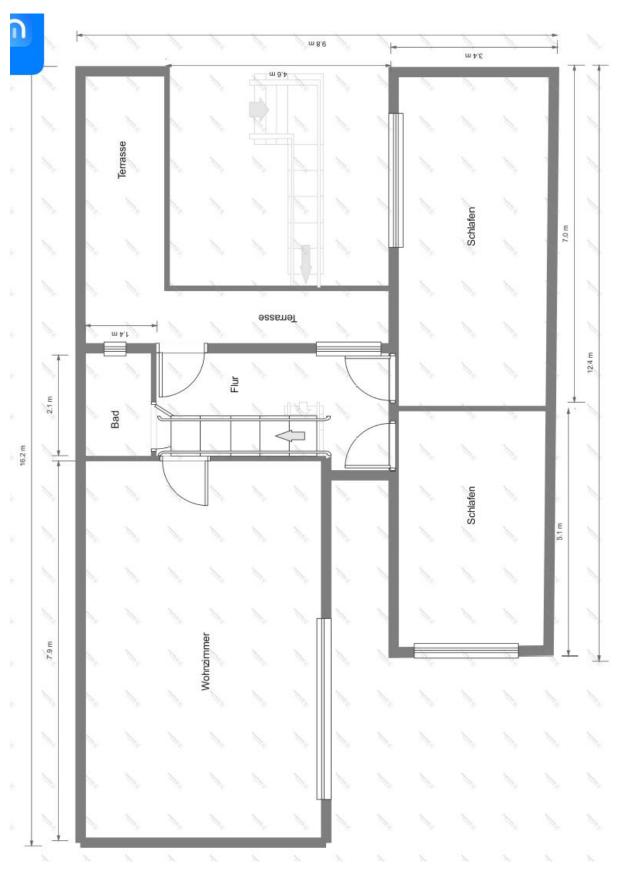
Grundriss OG, nicht maßstabsgetreu, Maße ohne Gewähr
